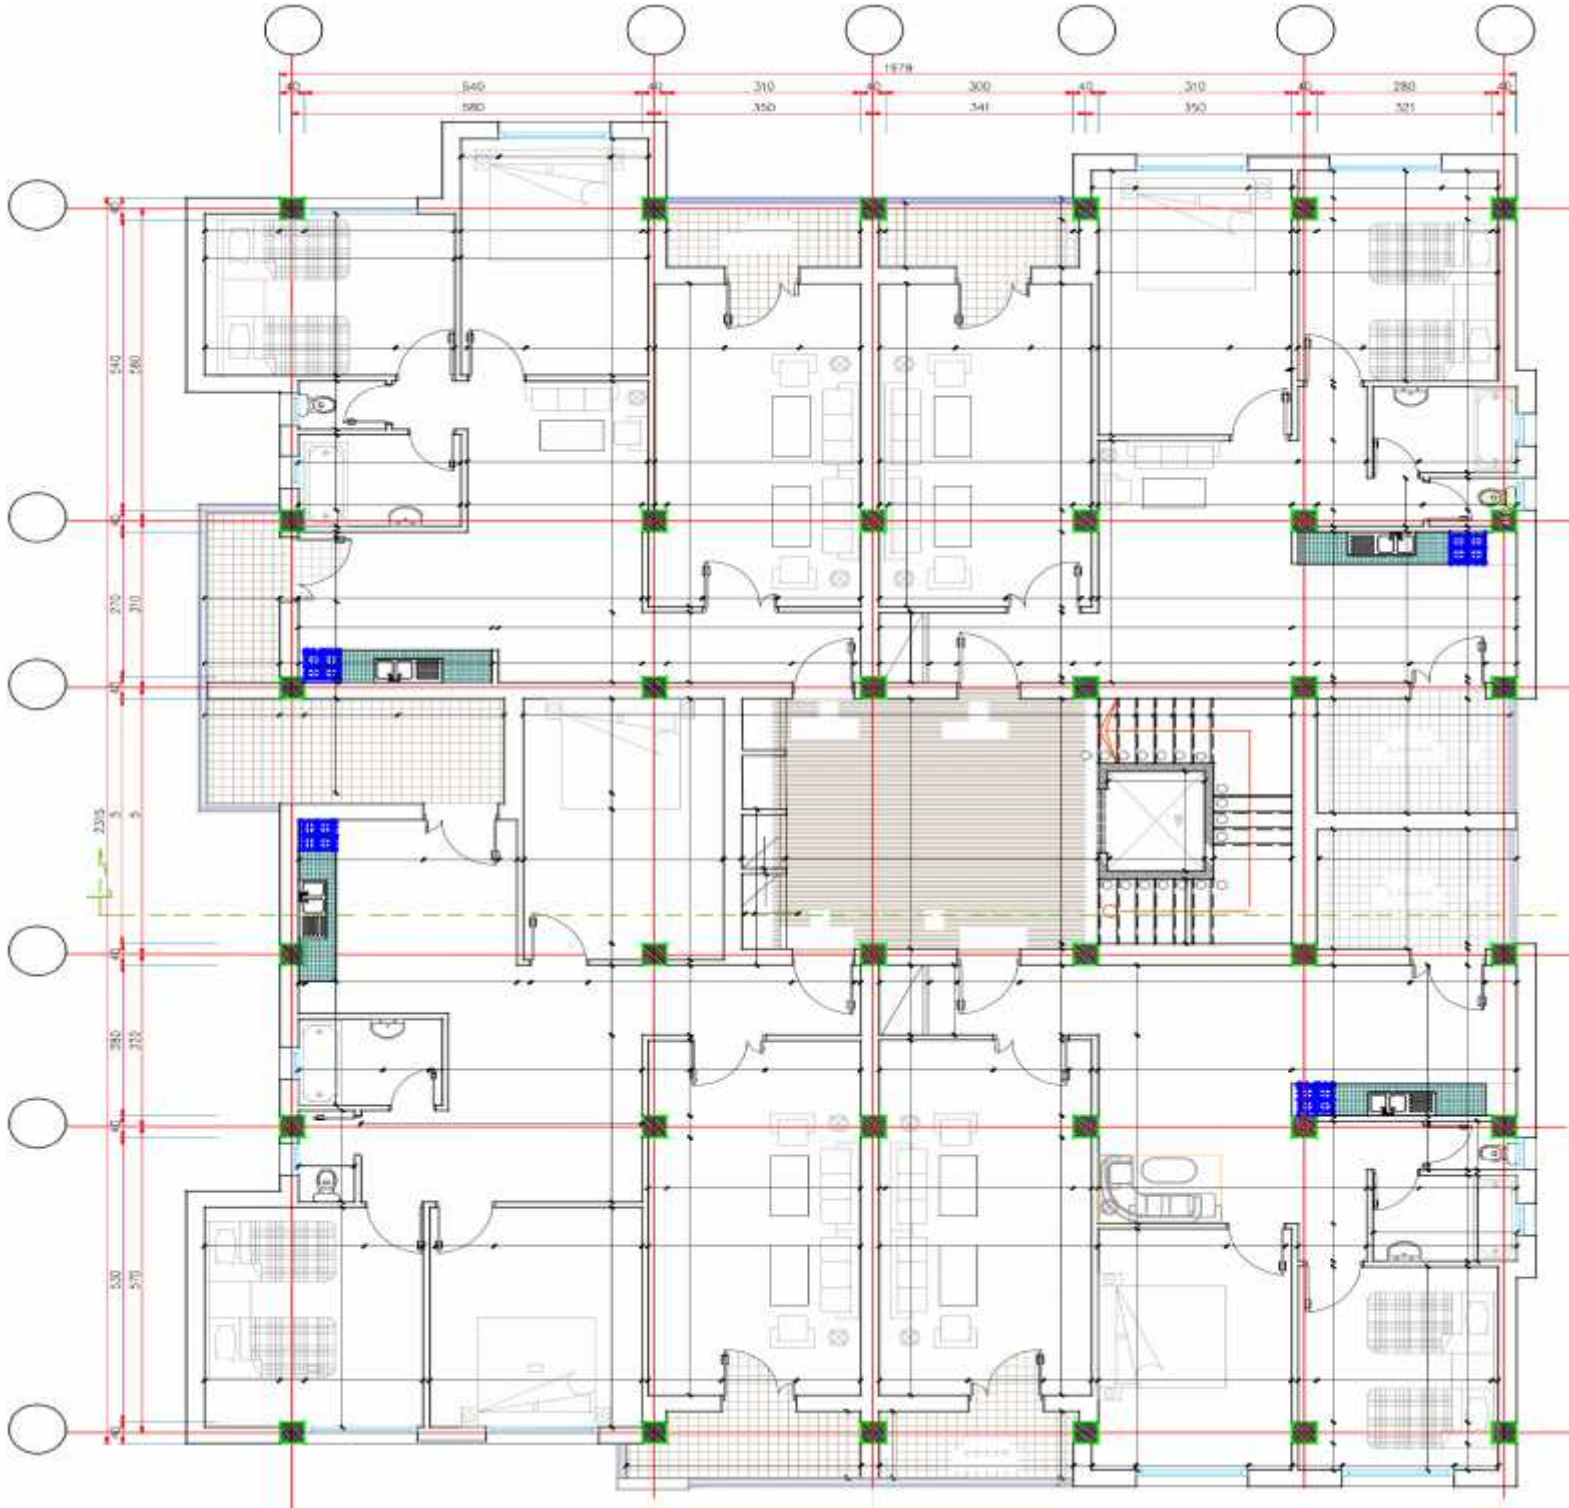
Vue en plan niveaux étage courant de la structure
